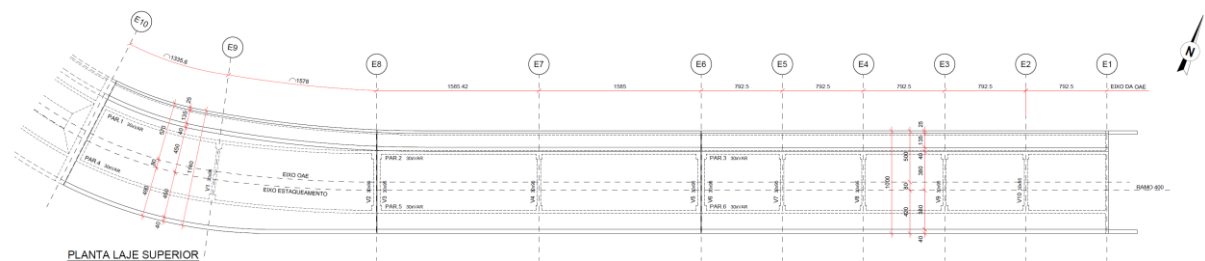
RAMO 400 - PLANTA ENCONTRO ESTRUTURADO (EIXOS E1 A E10)
